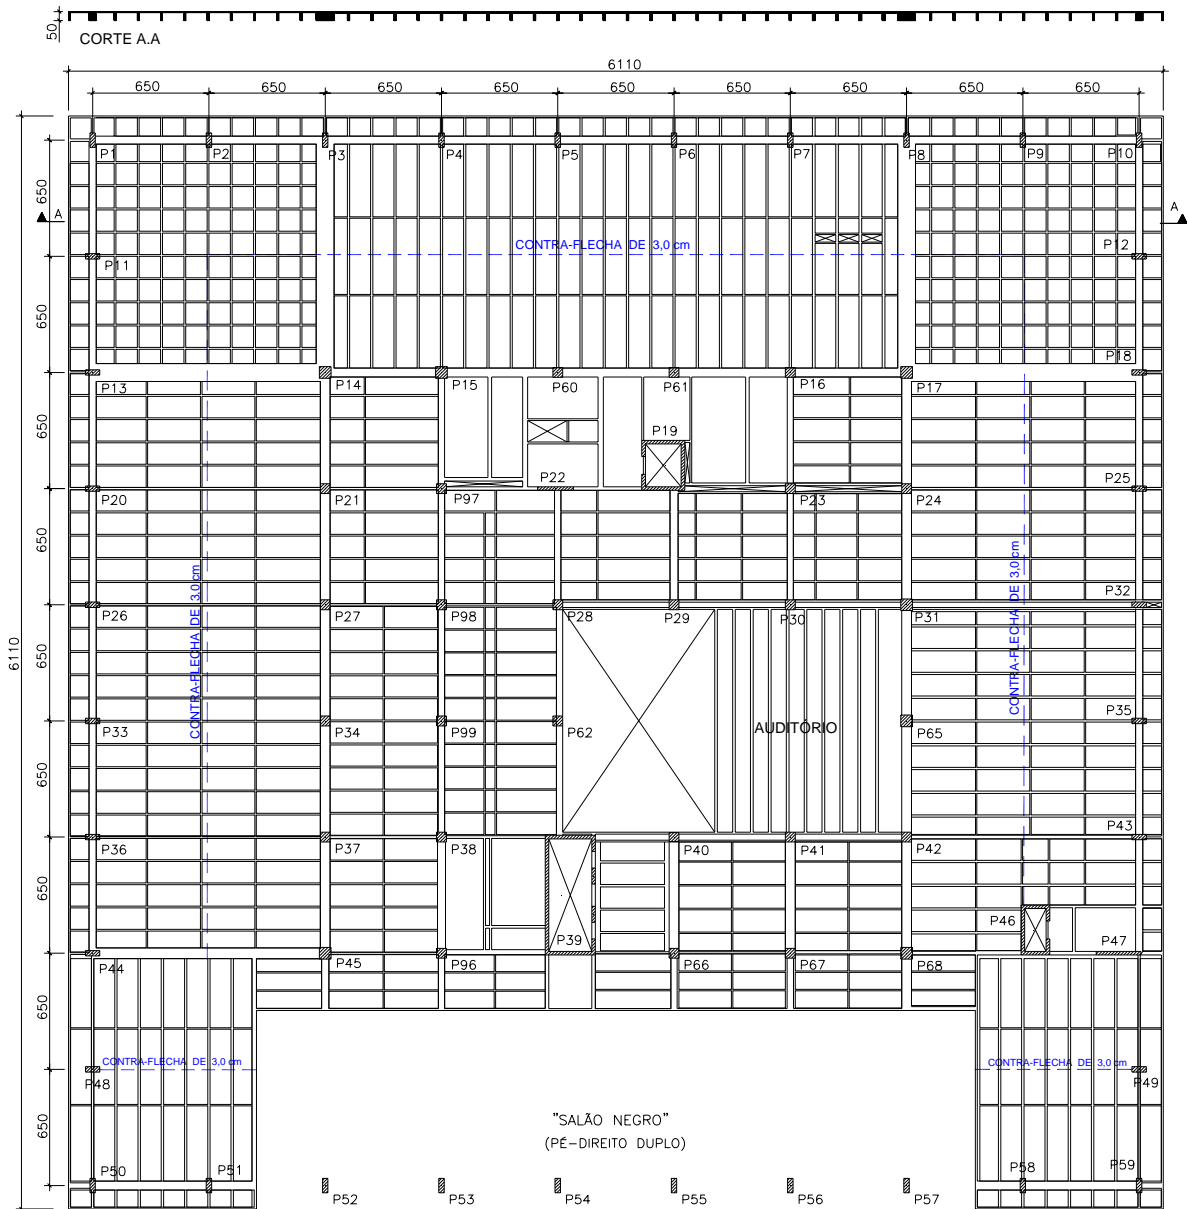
Fôrma do 2º. pavimento do Palácio da Justiça (sem escala)
